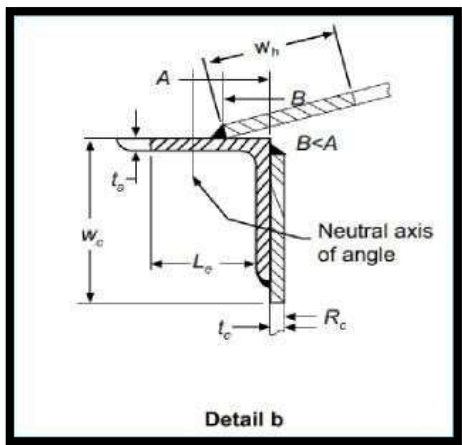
Detalle "b" para refuerzos superiores de la API 650
